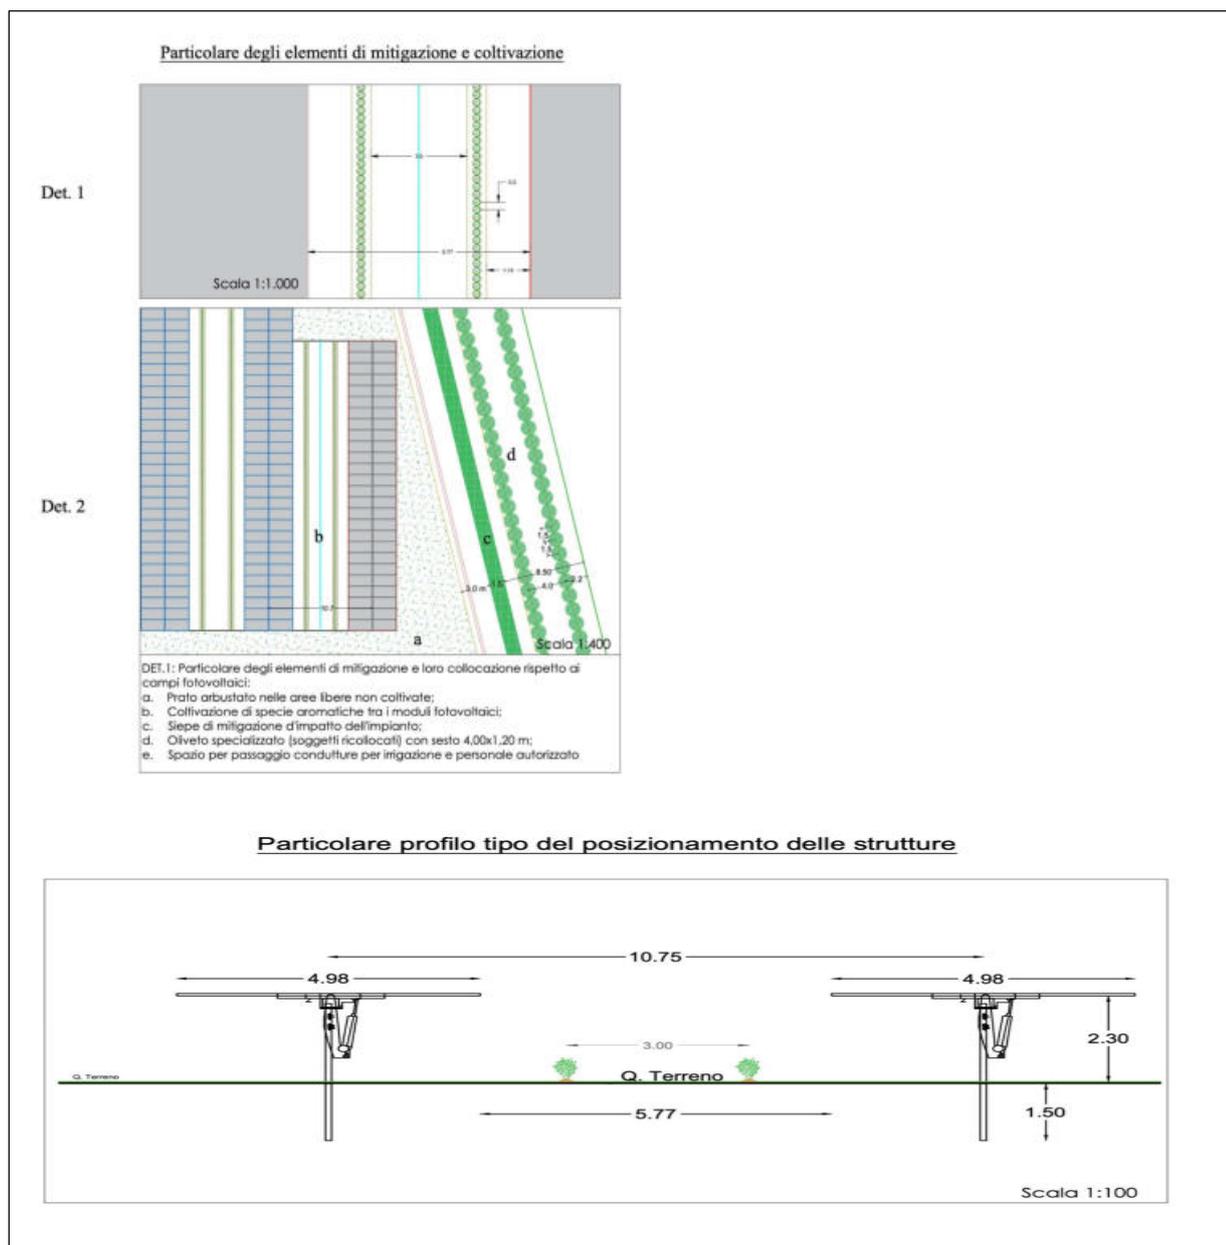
Particolare profilo tipo del posizionamento delle strutture
